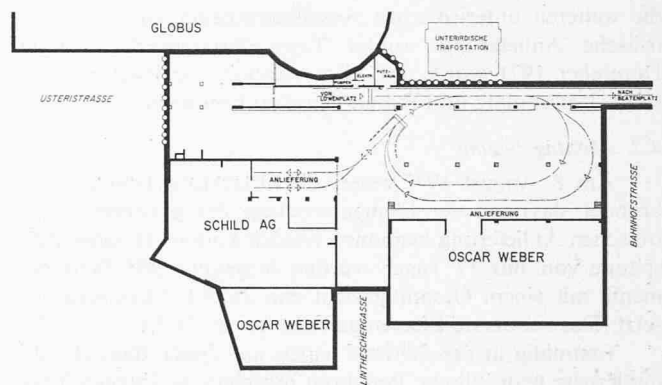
Grundriss des zweiten Untergeschosses der unterirdischen Anlieferung 1:700. Umschlag- und Verkehrsfläche nach dem Endausbau
